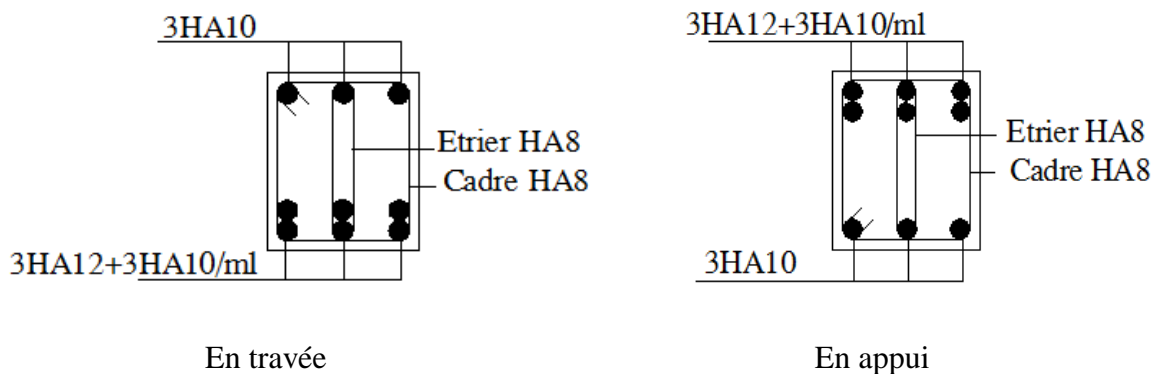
Schéma de ferrailage de la poutre brisée.
